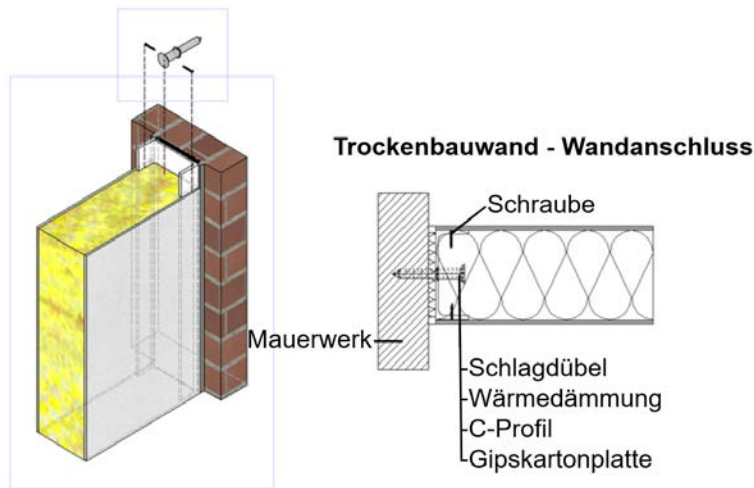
Beispielhafte Darstellung des Anschlusses einer Trockenbauwand an eine Mauerwerkswand, links: 3D-Darstellung als BIM-Modell, rechts: Schnittzeichnung als 2D-Darstellung.
